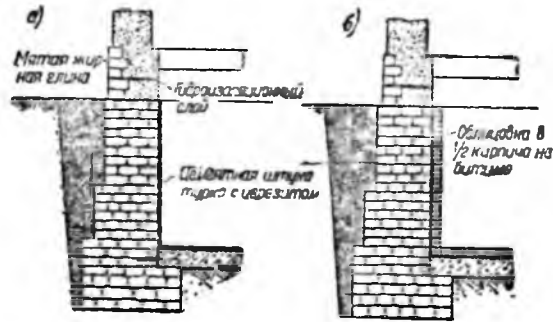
Гидроизоляция стен подвального этажа внутренняя
